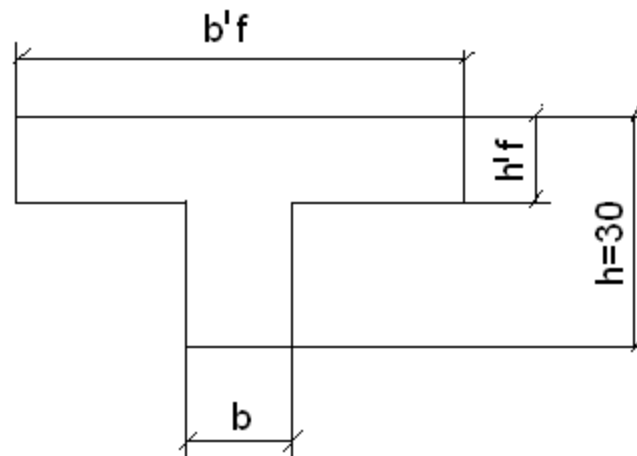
Схема визначення площі перерізу поздовжньої розтягнутої та поперечної арматури у поздовжніх ребрах
